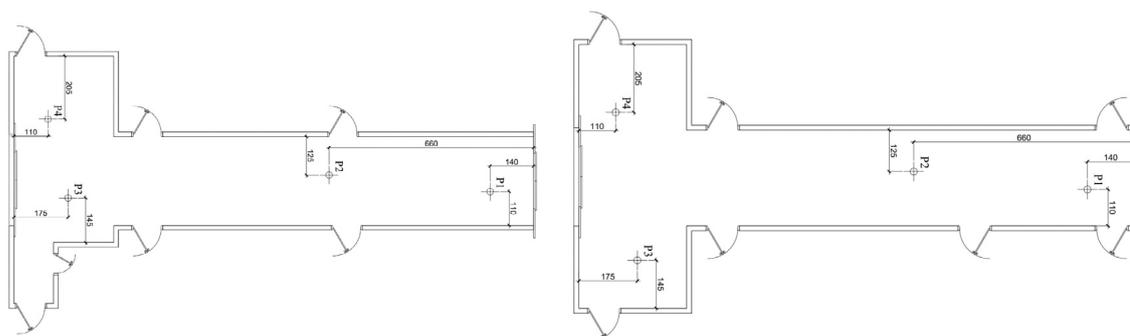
Locação de pontos (LAeq) no corredor do pavimento térreo (esq.) e pavimento superior (dir.)
